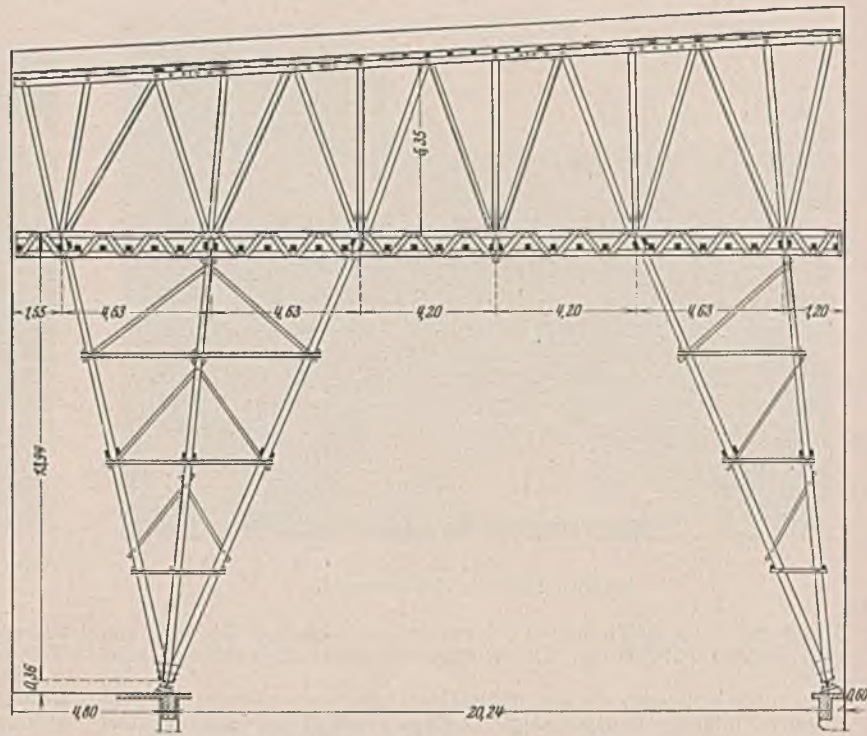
Gerüstbinder für das Kesselhaus des Krafthauses II.
